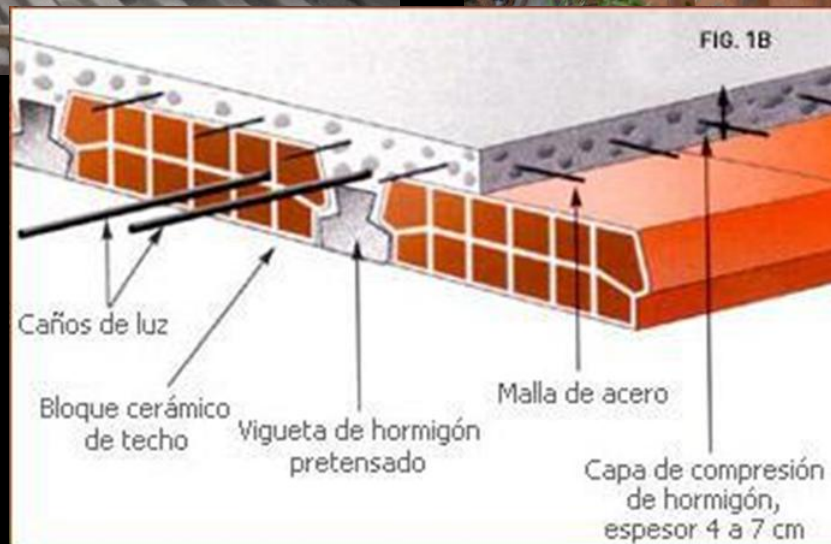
Sistema de losa sobre vigas maestras
